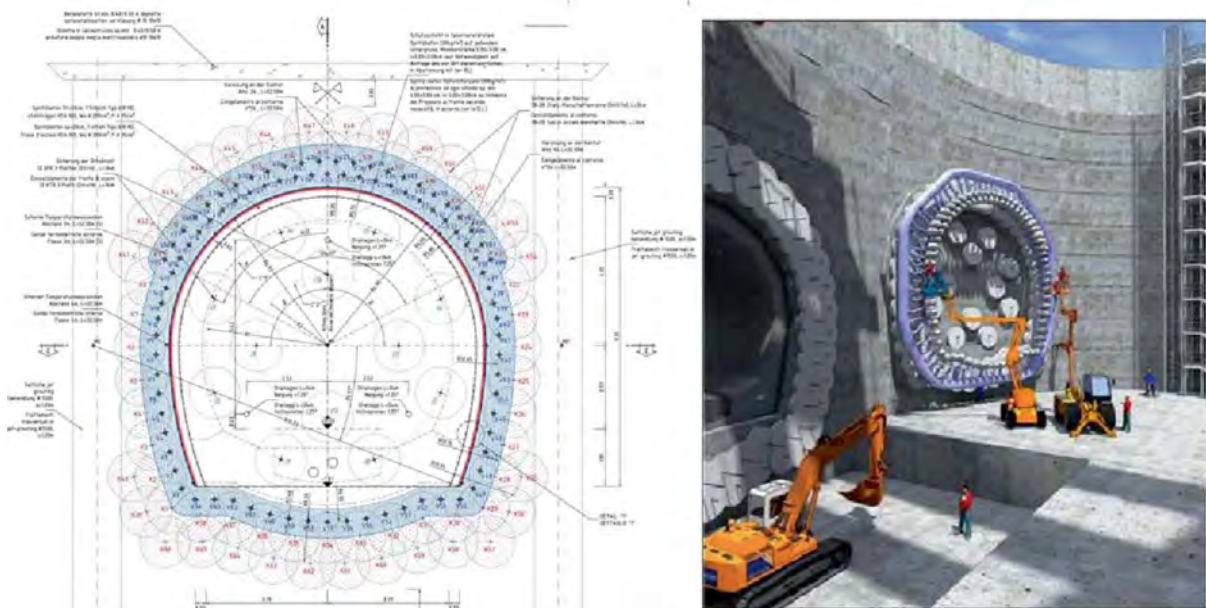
Sezione con interventi di consolidamento e schema prospettico
